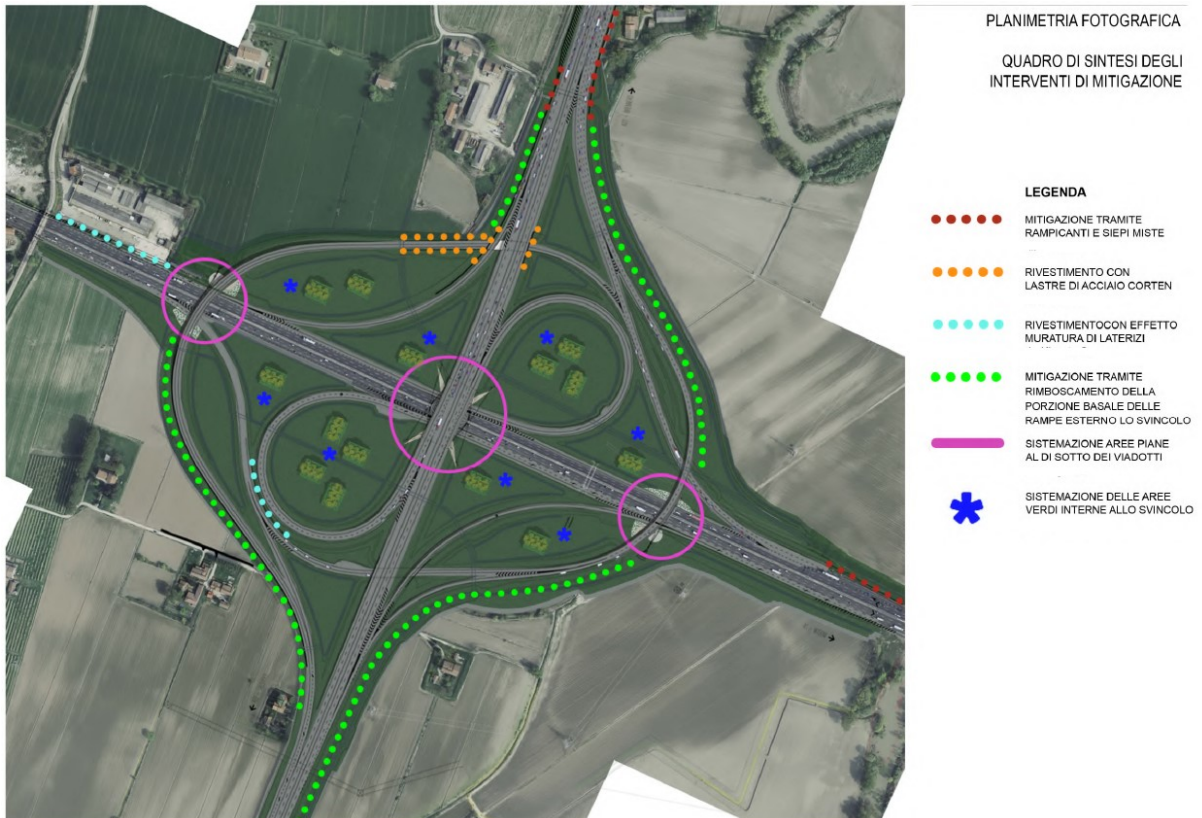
/6.4 – Planimetria degli interventi a verde previsti per lo svincolo A22/A1
